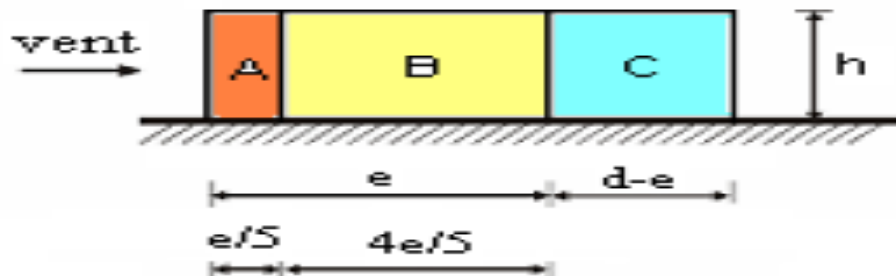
Vue en plan des zones de pression sur les parois verticales suivant le long pan
